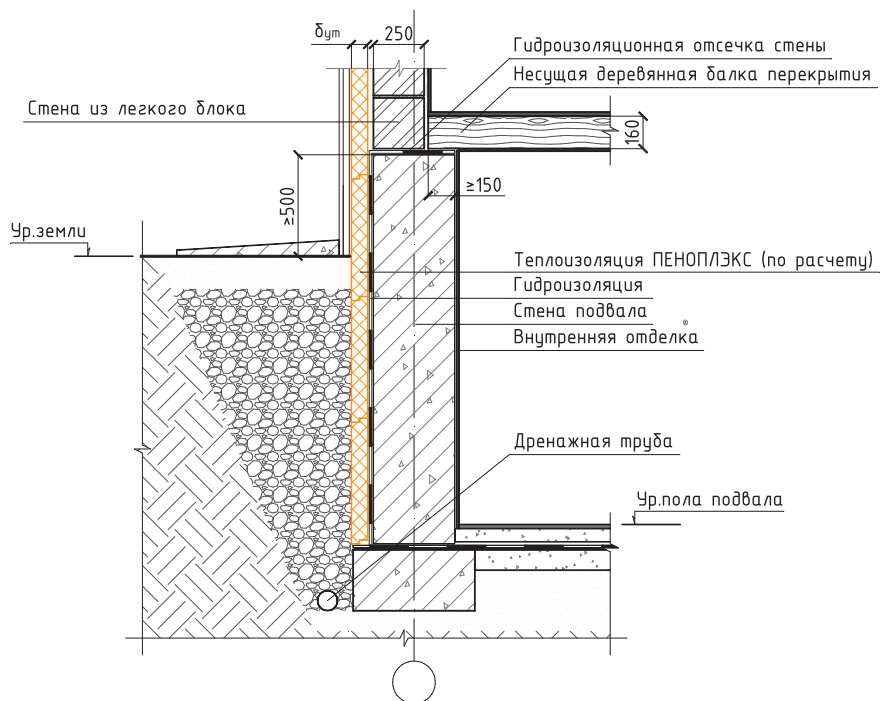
Схема сопряжения фундамента глубокого заложения и стены из облегченных блоков.
